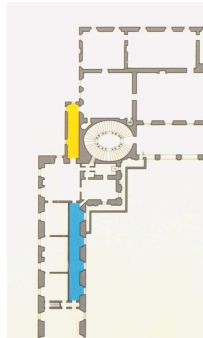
Grundriss des appartamento segreto unter Urban VIII.
